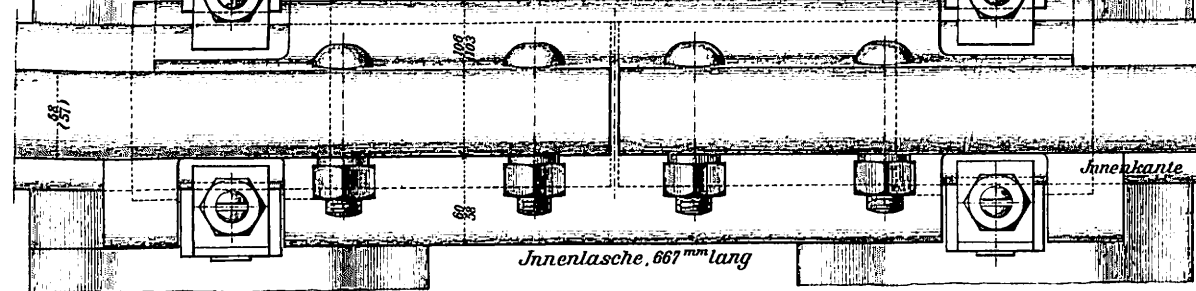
Grundriss des Stosses. (1:5 d. nat. Gr.)
